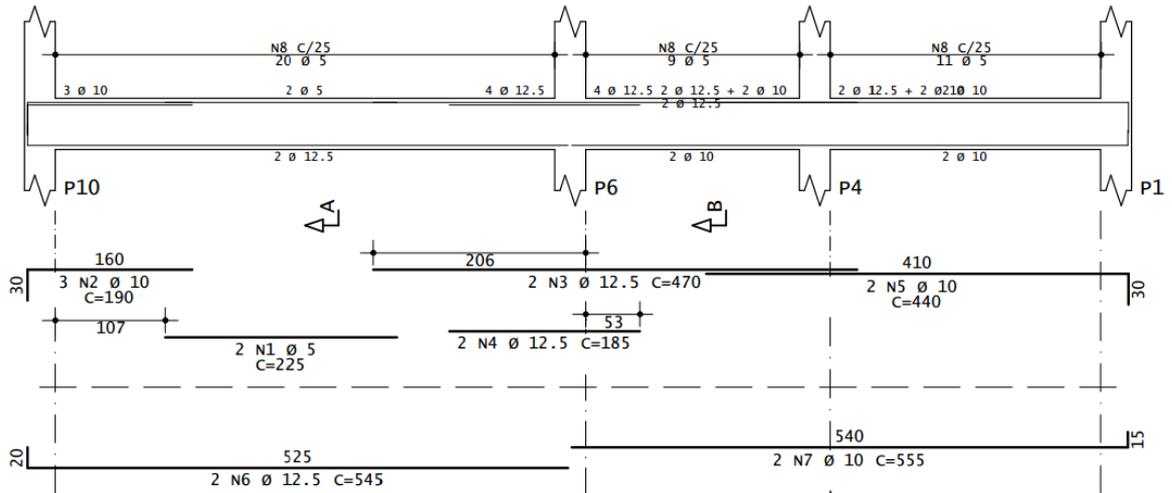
Armadura da viga V6 – pavimento superior (nível +3,00)
